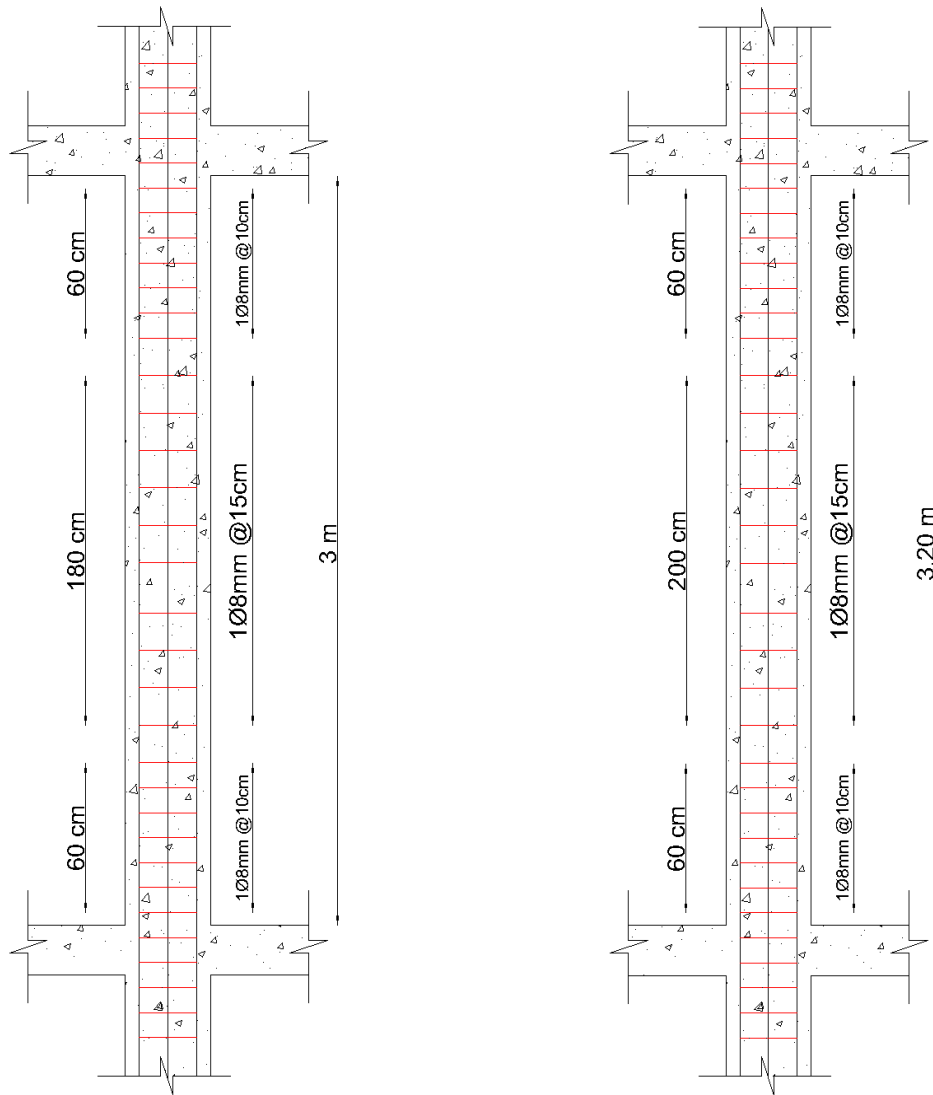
Detalles en elevación de la columna de 20x20 cm
